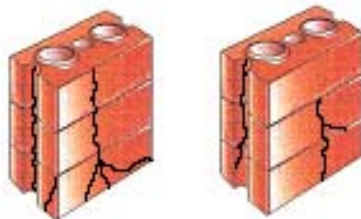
Fissuras no final do ensaio dos prismas-tipo e, com argamassa de injeção
